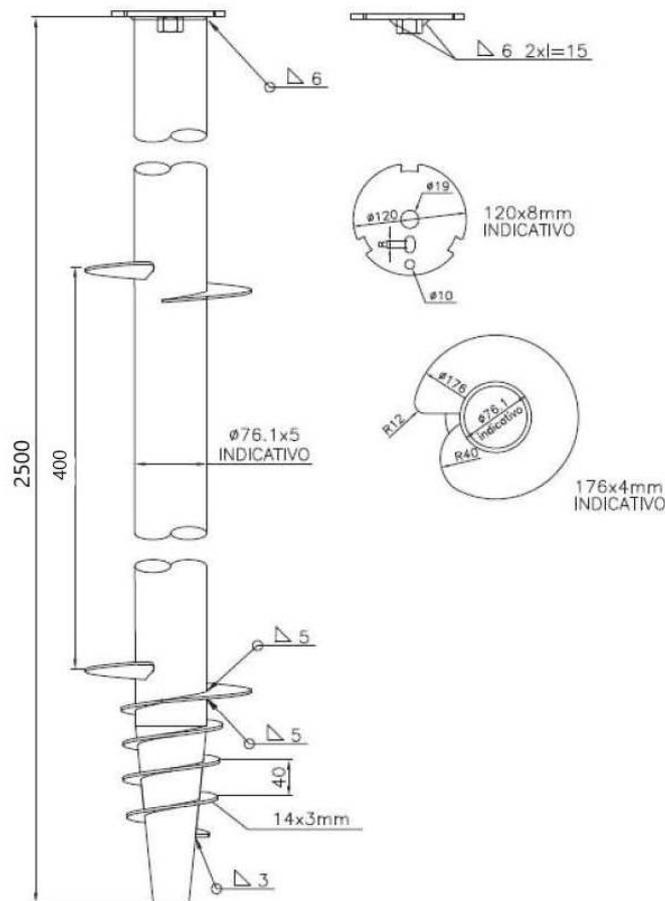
Particolare della vite di fondazione delle strutture tracker.
